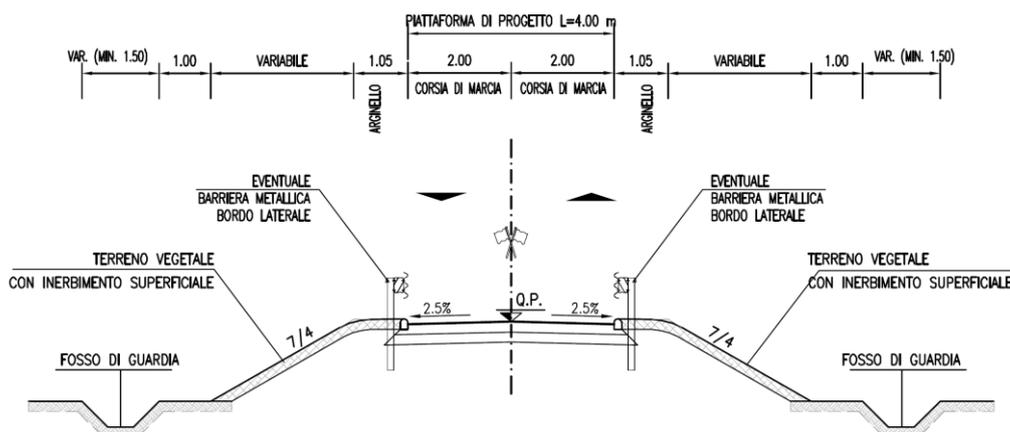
Sezione tipo in rilevato – Strada a destinazione particolare
